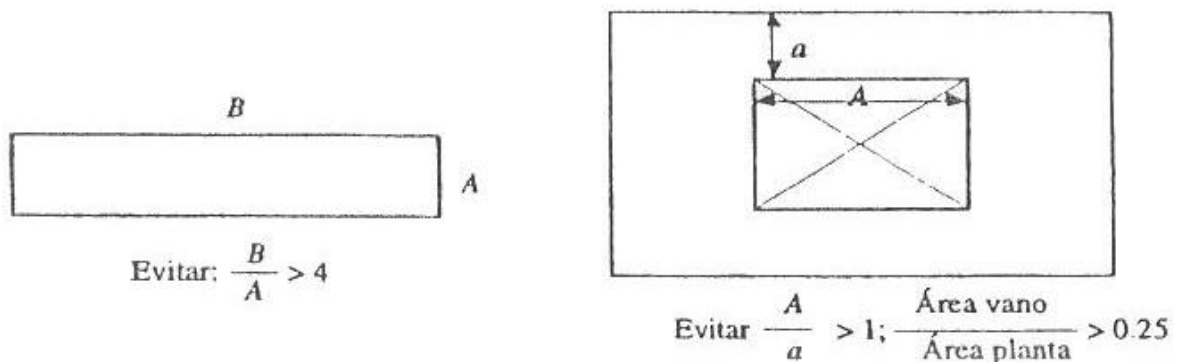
Límites recomendables para los lados de la planta de un edificio [Bazán, E., Meli, R. (2002)]
